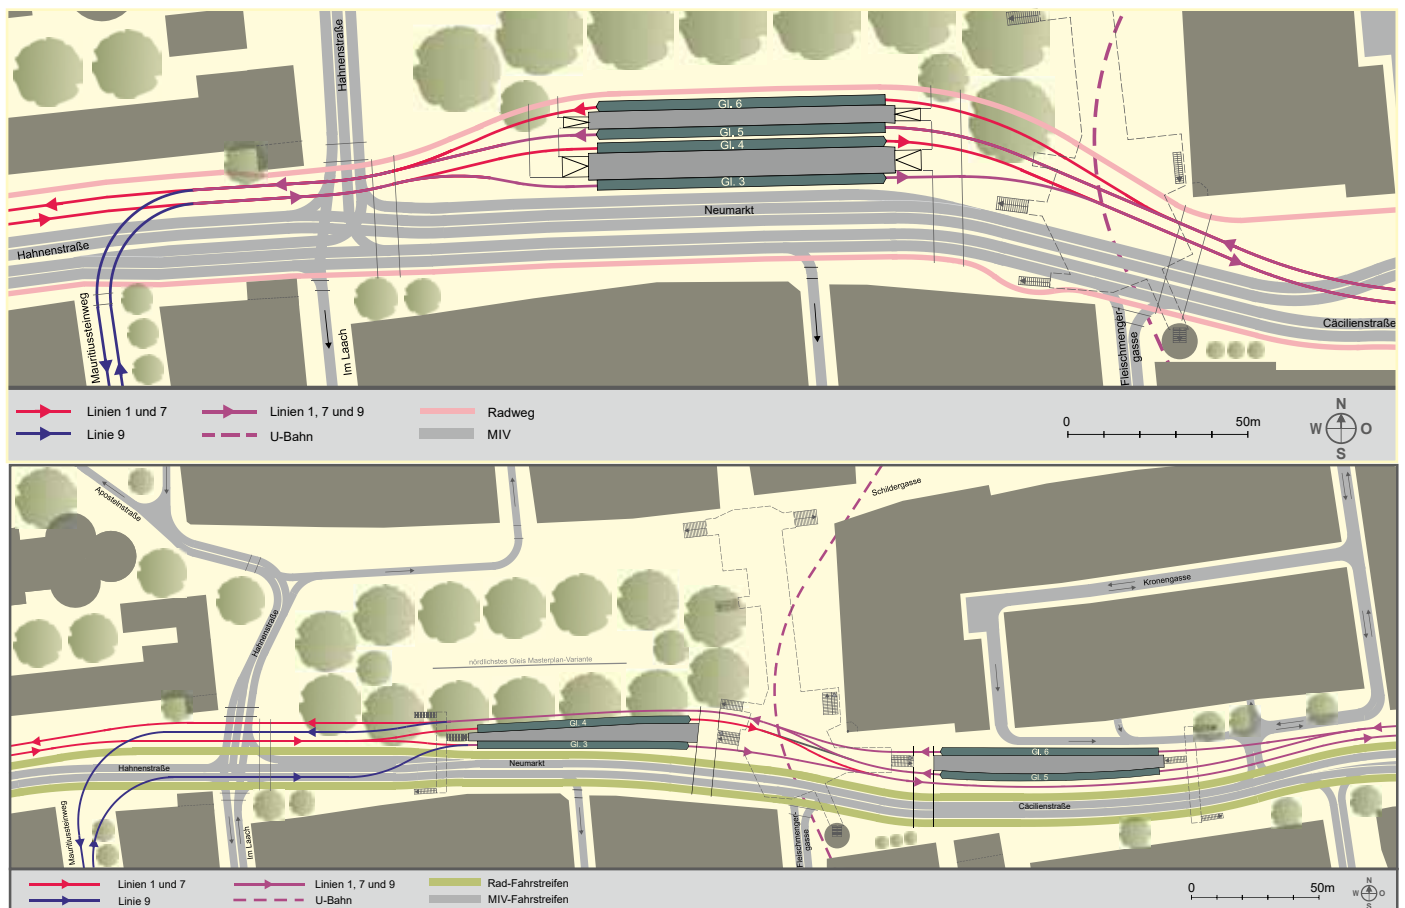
Lageplan gemäß Masterplan (oben) und Abb. 8: Station Neumarkt, Bahnsteige hintereinander (unten)
